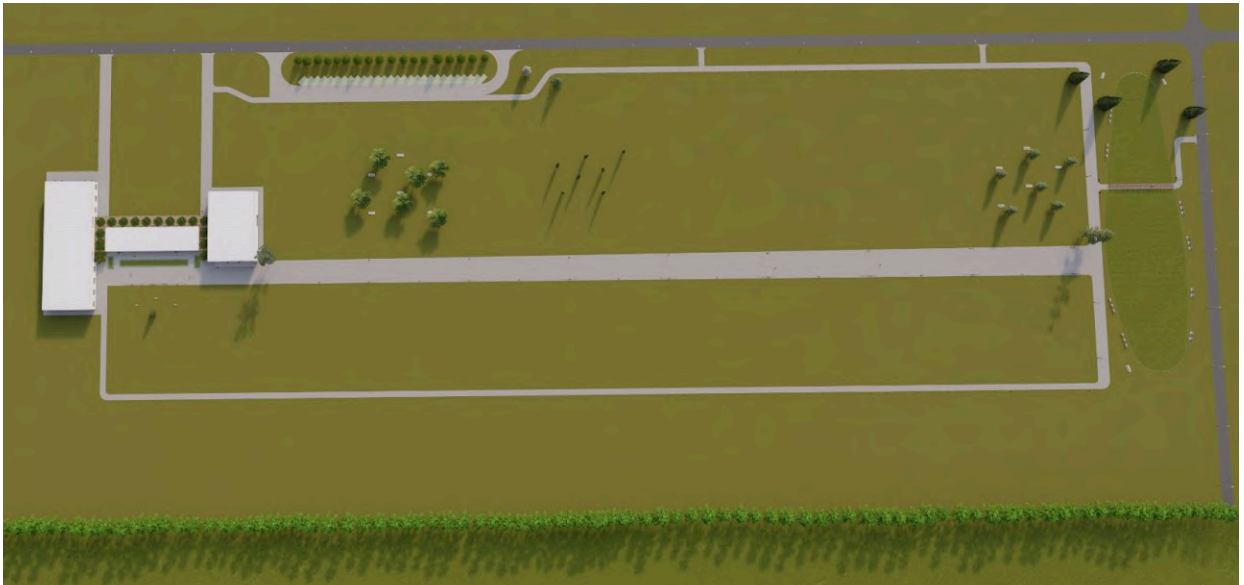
Planta del conjunto edilicio. Fuente: Elaboración propia.
